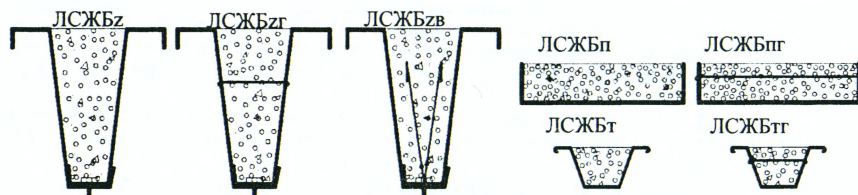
Типы лёгких сталежелезобетонных балок
